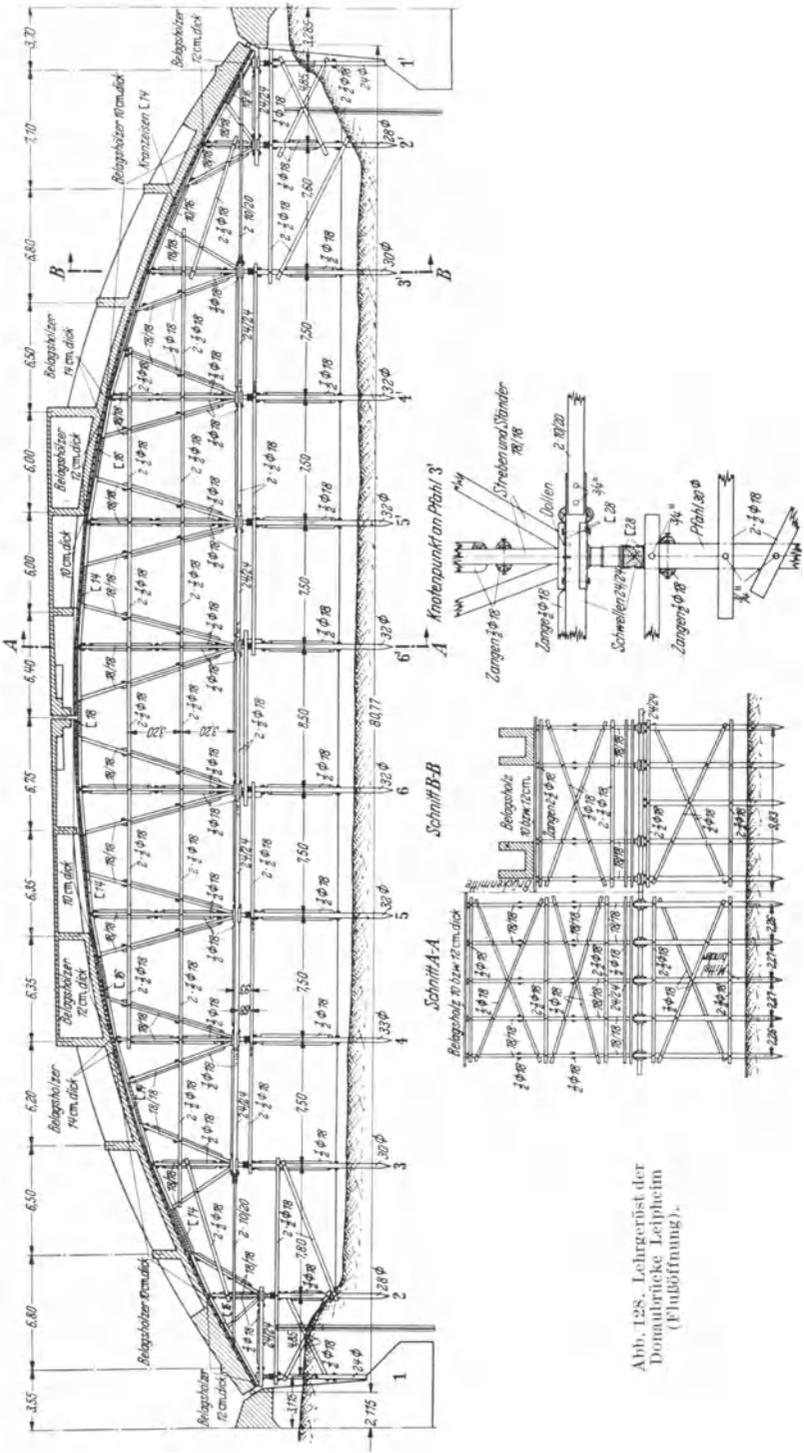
LeGERüst der Dombrücke Leiphelm (Fußgängerbr.).
